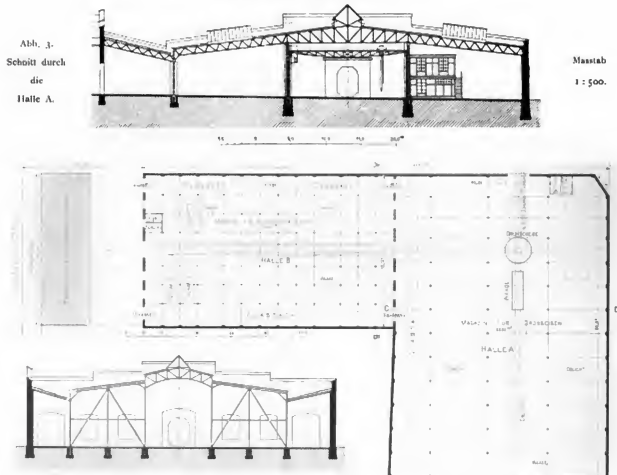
und 2. Grundriss der ganzen Hallenanlage (Massstab 1:1000) und Schnitt durch die Halle B (Massstab 1:500).
